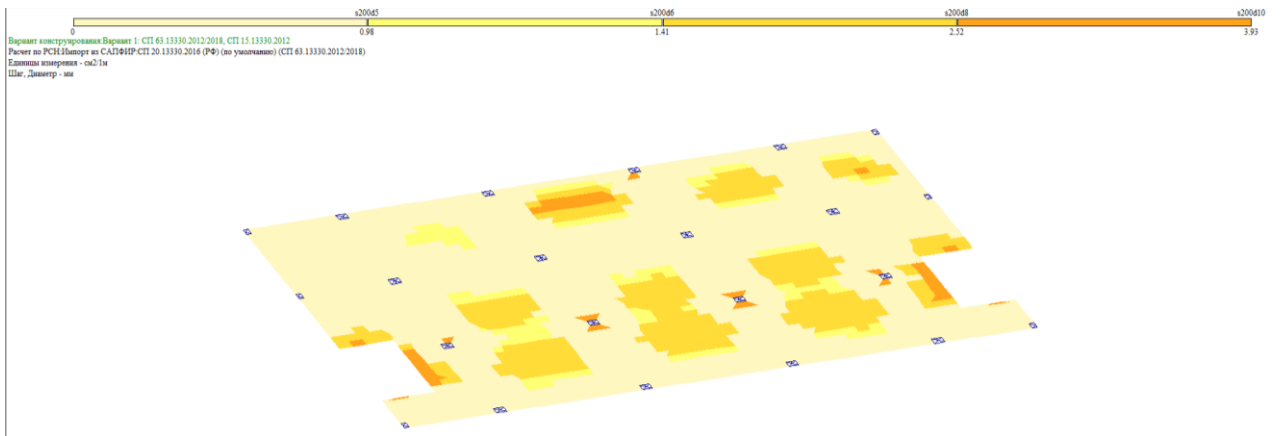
Схема армирования низа плиты по оси ОУ
